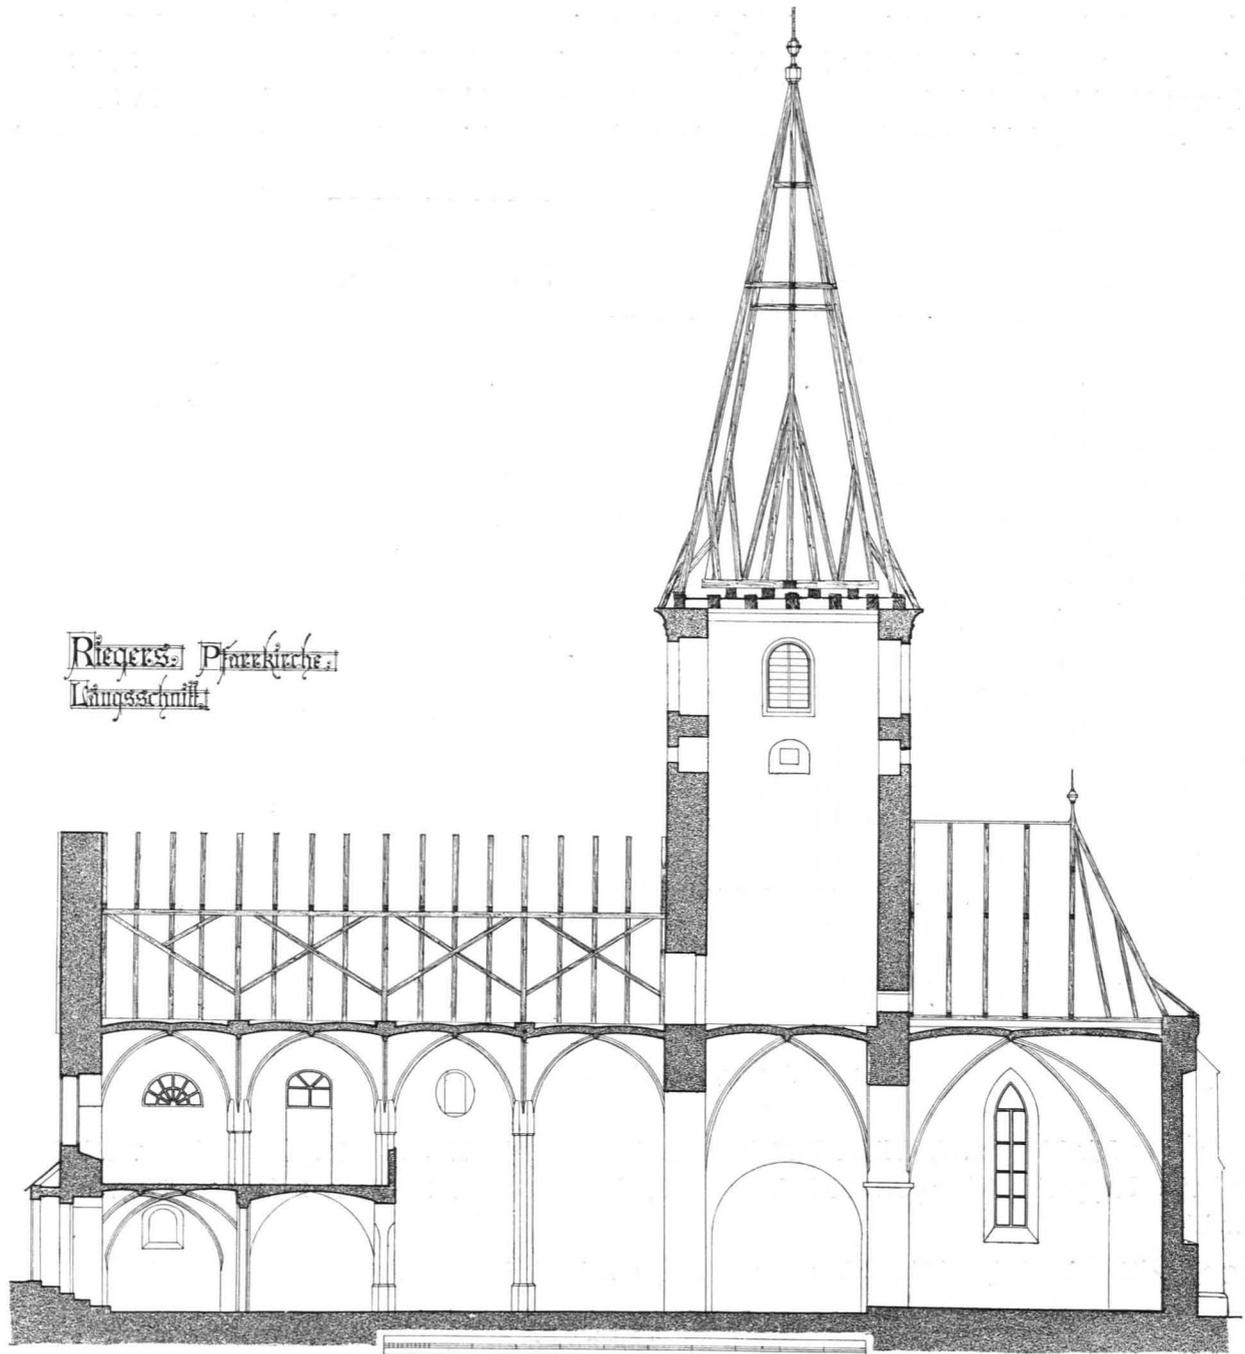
Riegers, Pfarrkirche, Längsschnitt 1 : 175 (S. 373)
